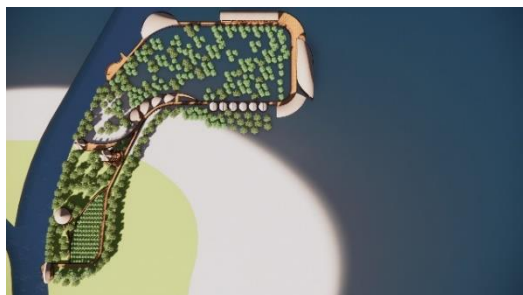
Layout Plan Ekowisata Mangrove Patuguran
